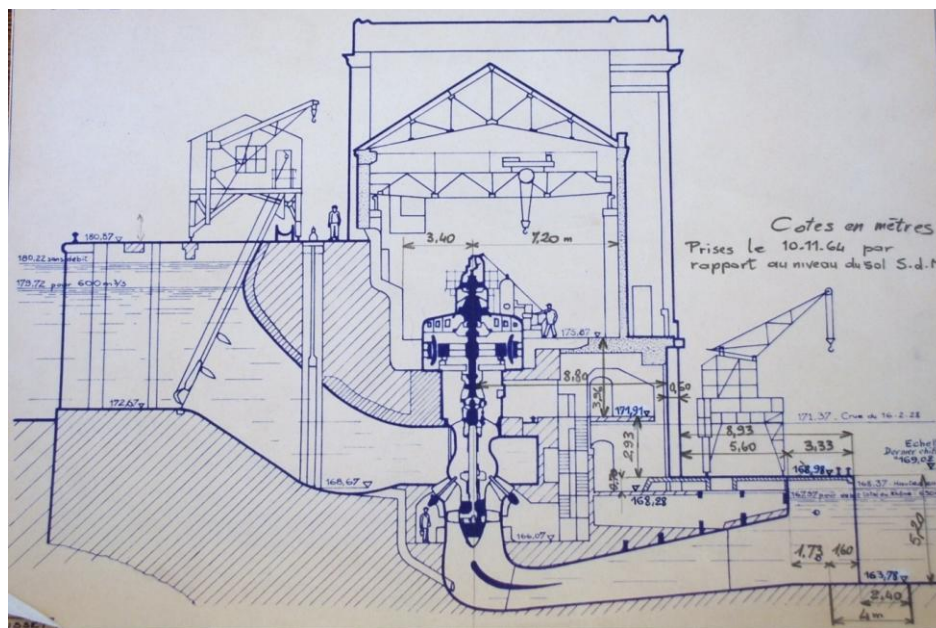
Coupe transversale de l'usine barrage suivant l'axe d'un nouveau groupe (156 J 1)
